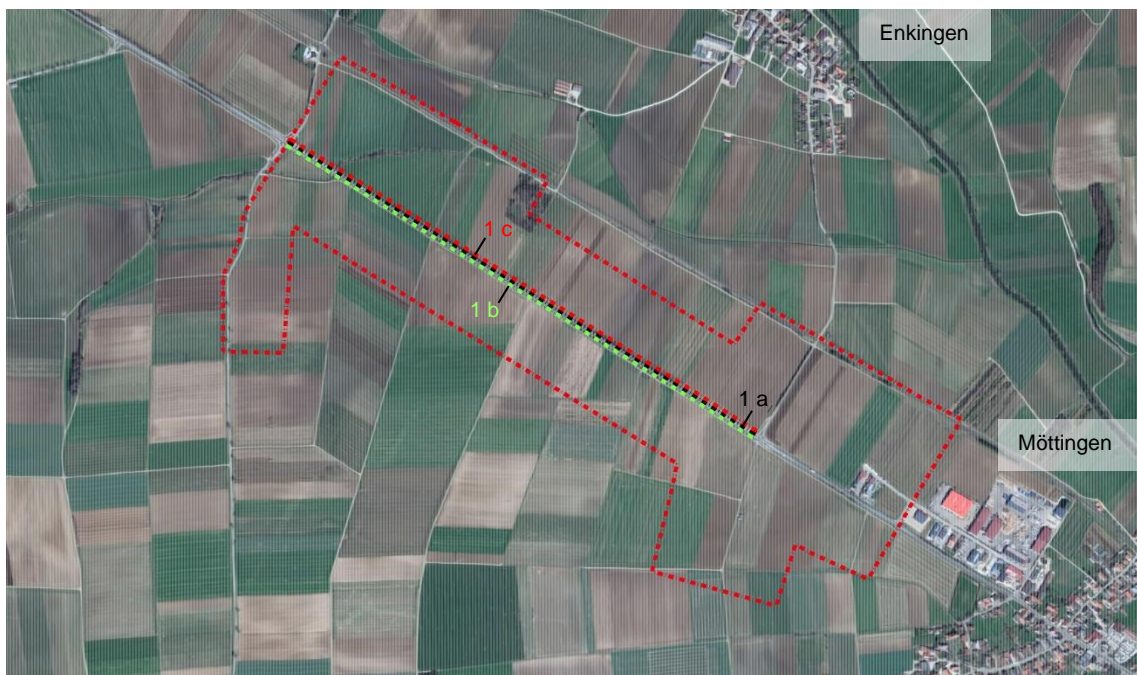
Planungsvarianten (1a, 1 b und 1c) des Bauabschnittes 3
